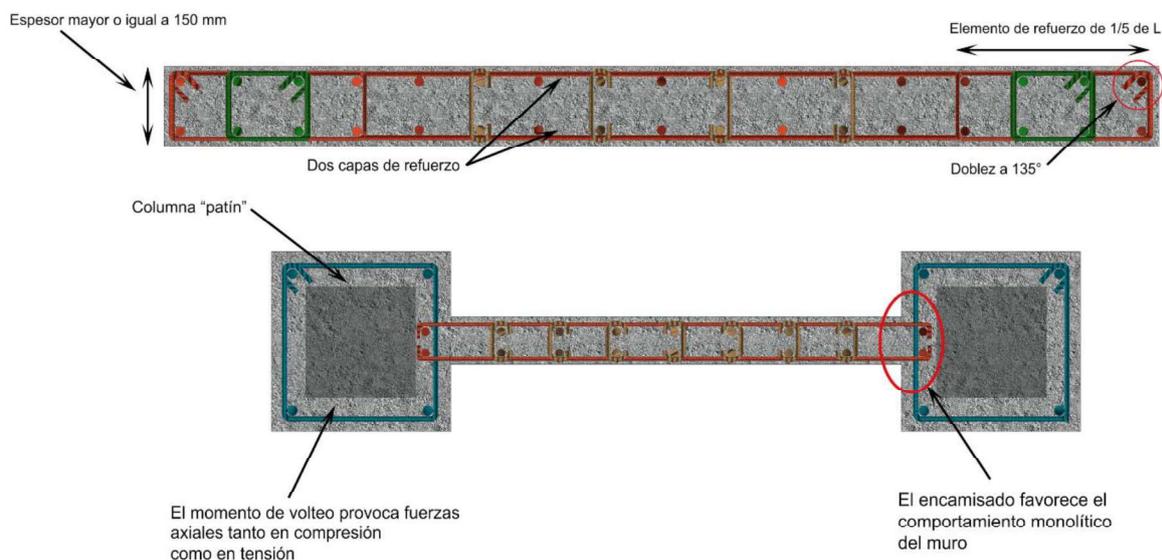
Elemento de borde en cada extremo del muro o del segmento de muro. Fuente: INIFED (2021d) con base en Terán (2009)
